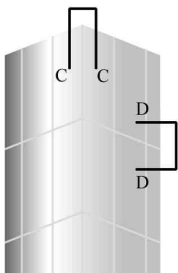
A: Detail dwarsverbinding. Voorbeelden van structurele beglazingsontwerpen: 2-zijdig ontwerp (ter plaatse aangebracht).
